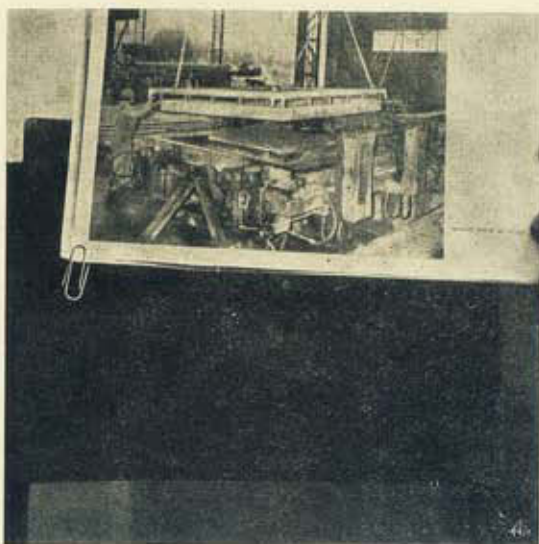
Colocação em molde de um caixilho de elemento de fachada.
